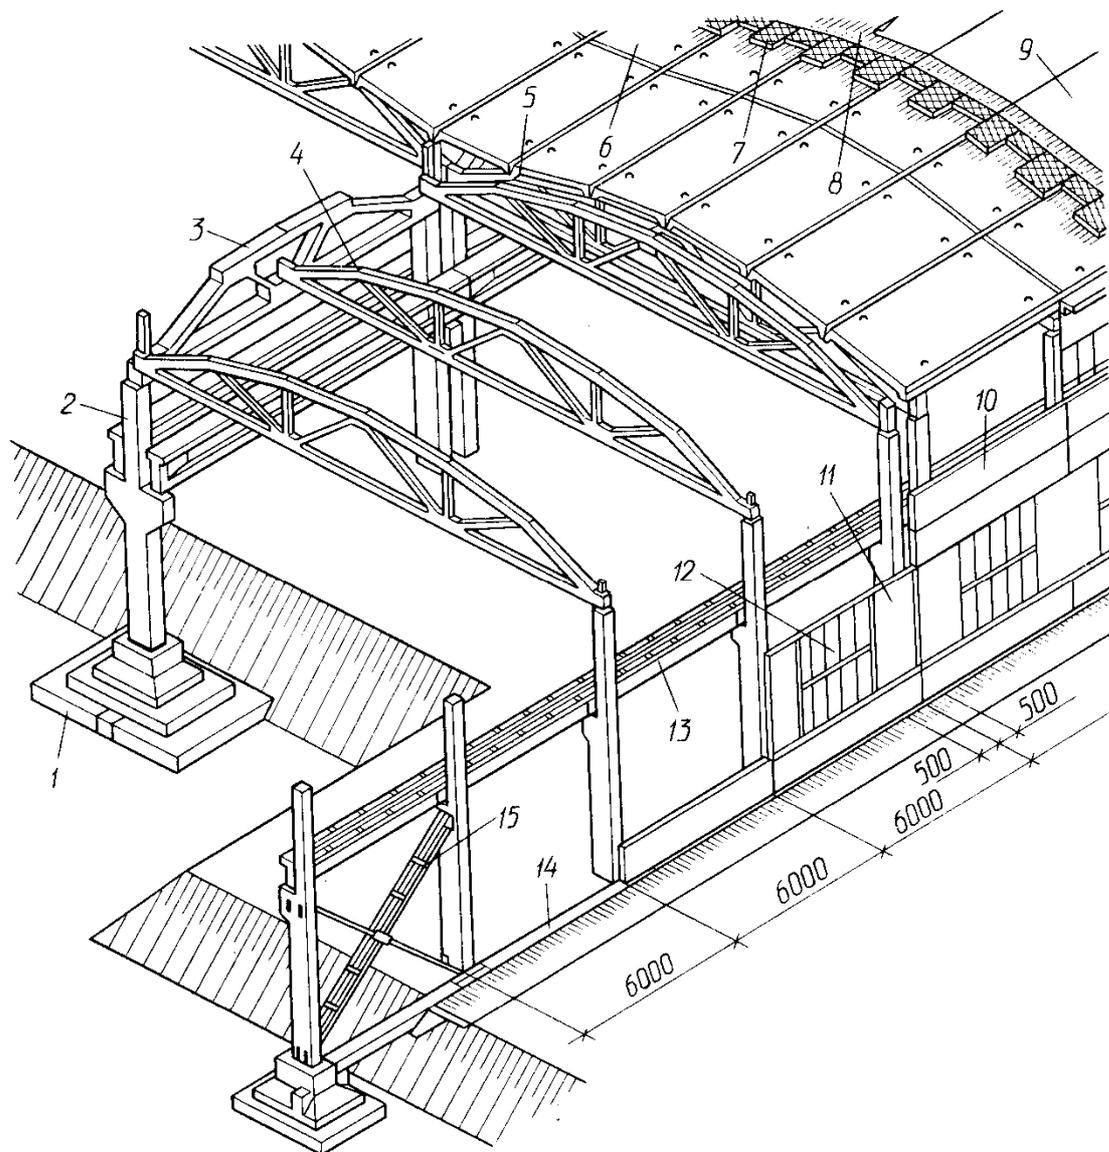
Железобетонный каркас со стропильными фермами:
